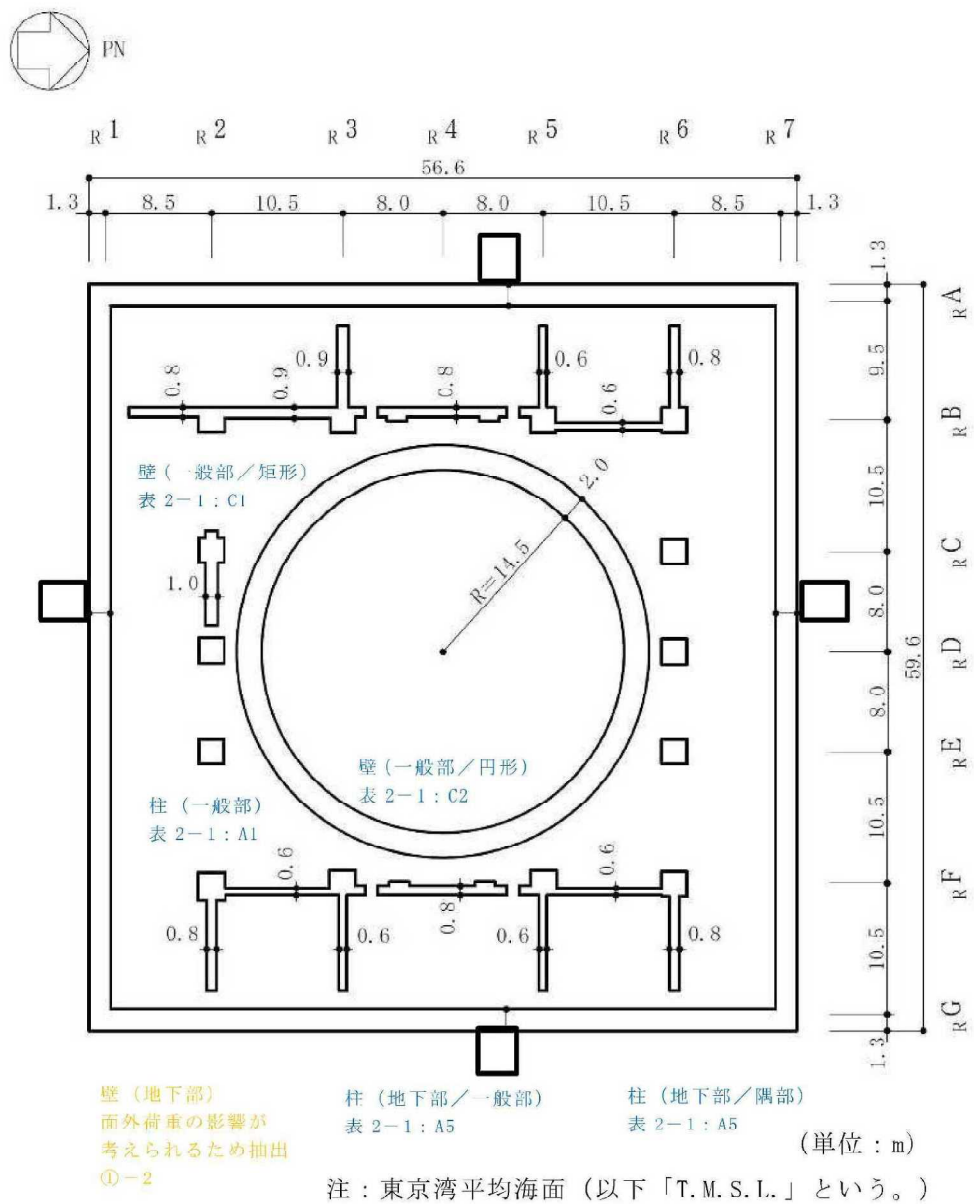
原子炉建屋の概略平面図（B3F, T.M.S.L. -8.2m）（1/8）
